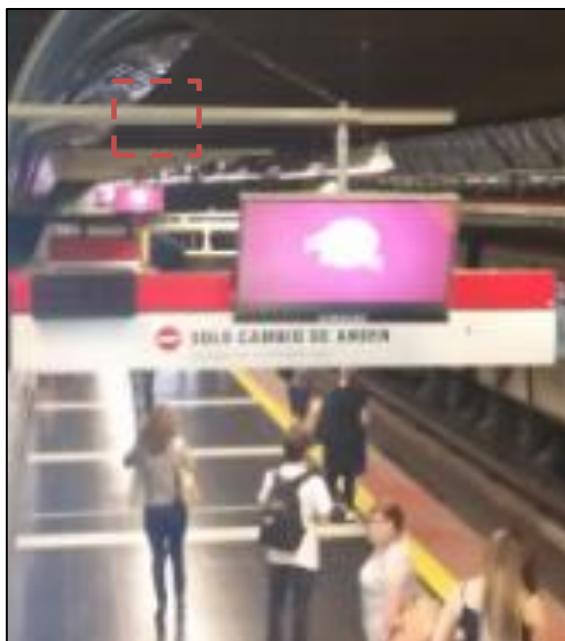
Mástil Horizontal Existente Lado Poniente
